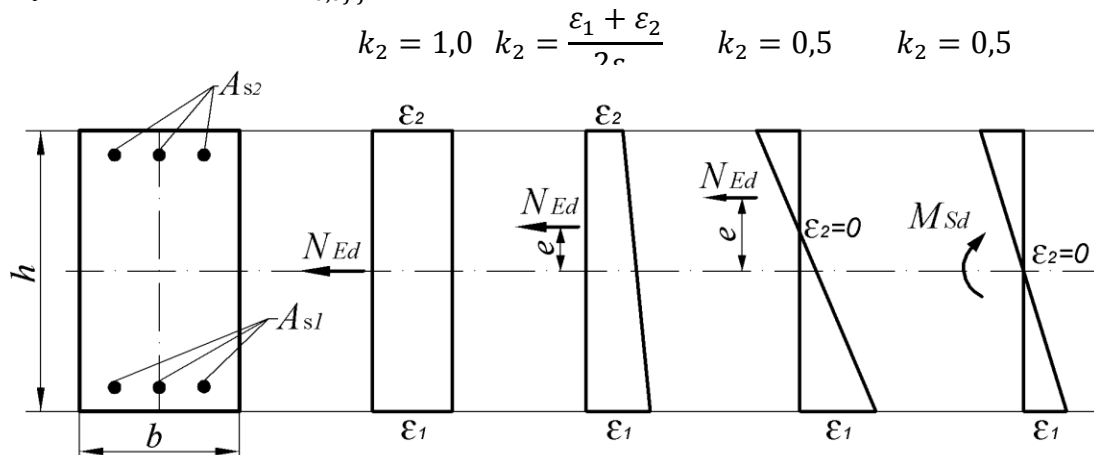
К определению коэффициента k_2 в формуле (8.24)
